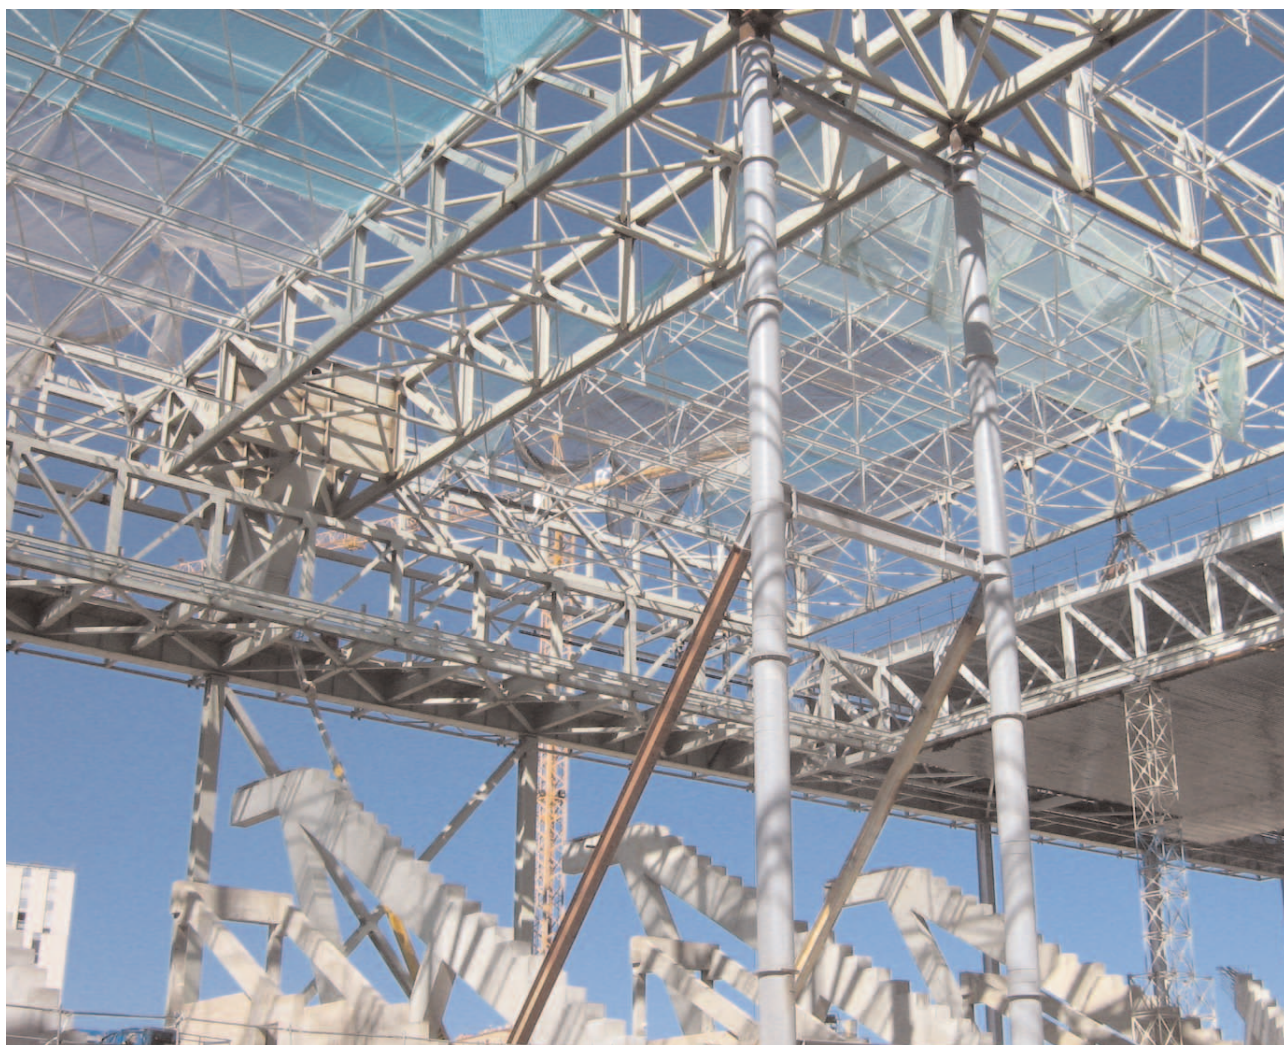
Montaje de la estructura de la Cubierta Móvil 1 con torres de apeo provisionales.
